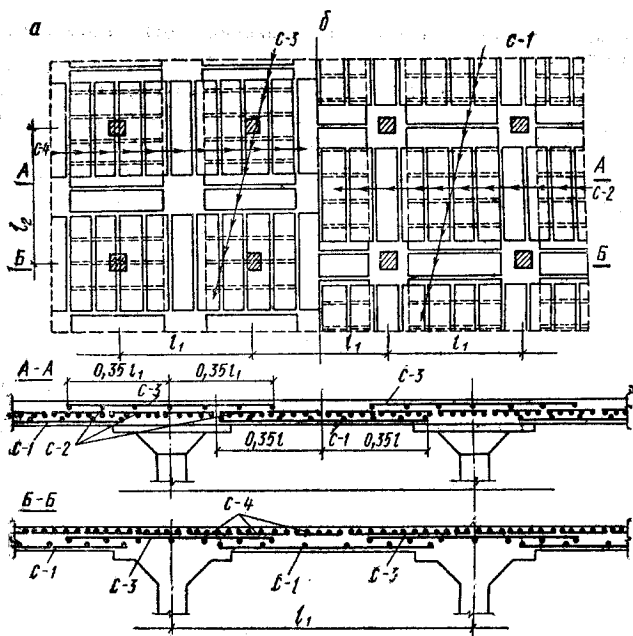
Армирование безбалочного перекрытия узкими сетками
